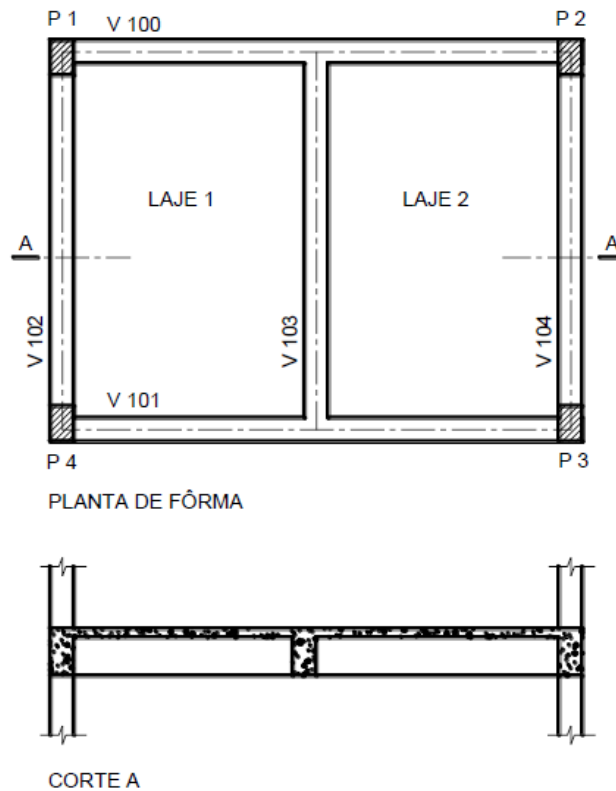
Planta de forma e corte de duas lajes maciças apoiadas sobre vigas. Fonte: Bastos, 2019.
